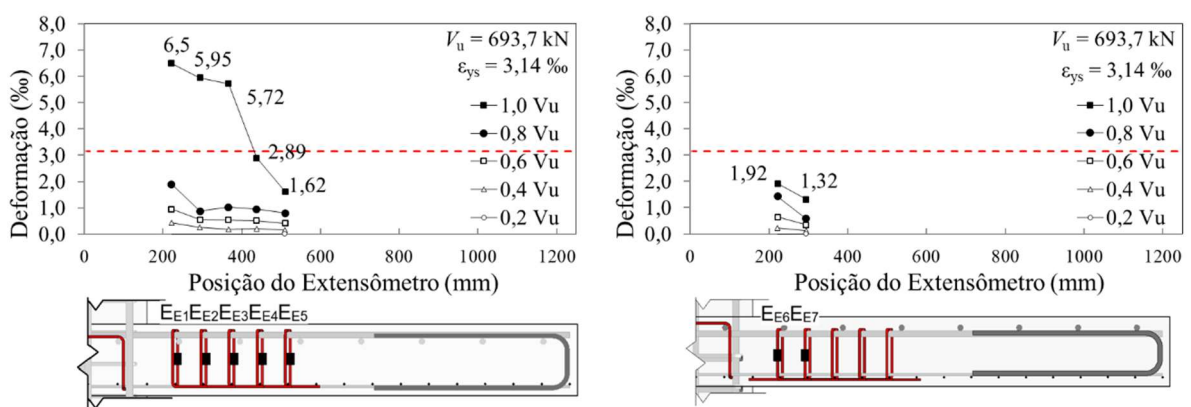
Deformação da armadura de cisalhamento na laje CFA
